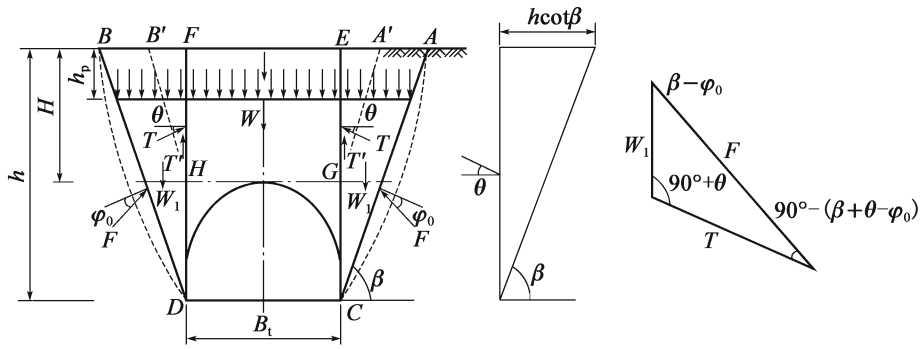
Schéma de pression du terrain encaissant du tunnel à faible profondeur
